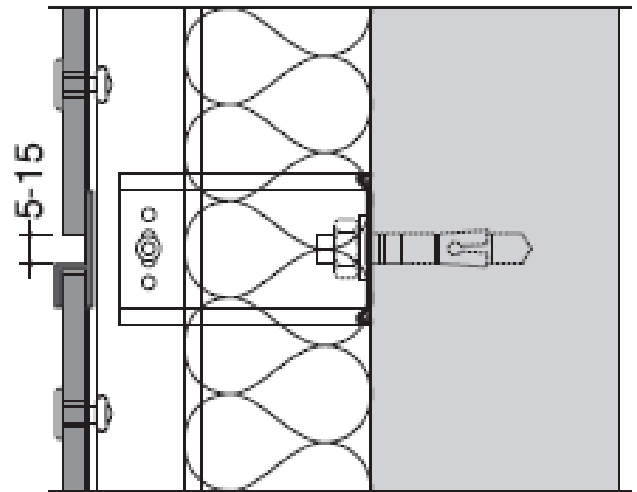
Coupe verticale sur joint horizontal (joint fermé)
